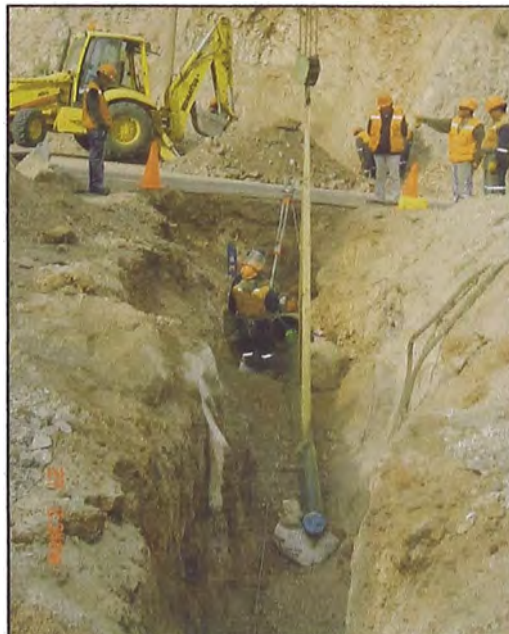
Pase de la tubería por la Alcantarilla en pista asfáltica
